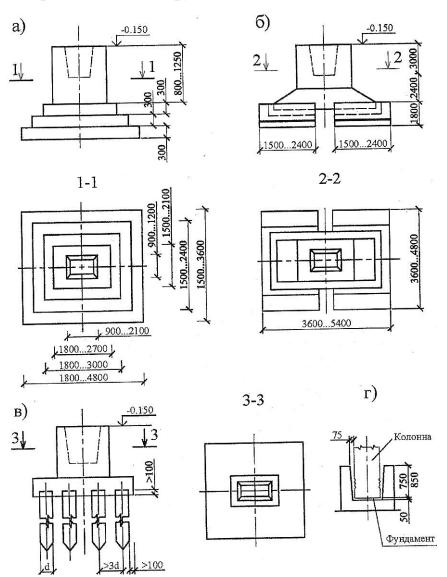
Фундаменты под железобетонные колонны: а- монолитный, бсборный, в – свайный, г- заделка колонны в фундаменте
